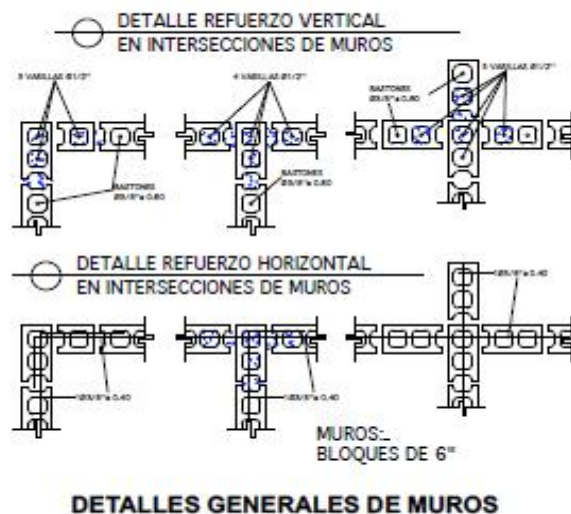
Detalles generales muros de bloques Edificios Banco Ademi
